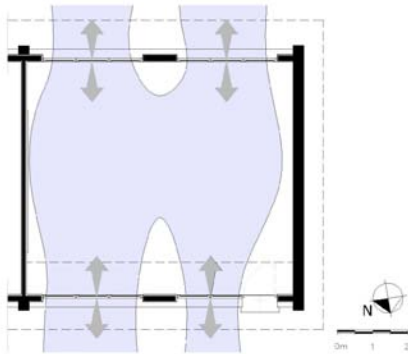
planta baixa da sala de aula padrão com esquema de ventilação – ventilação cruzada
